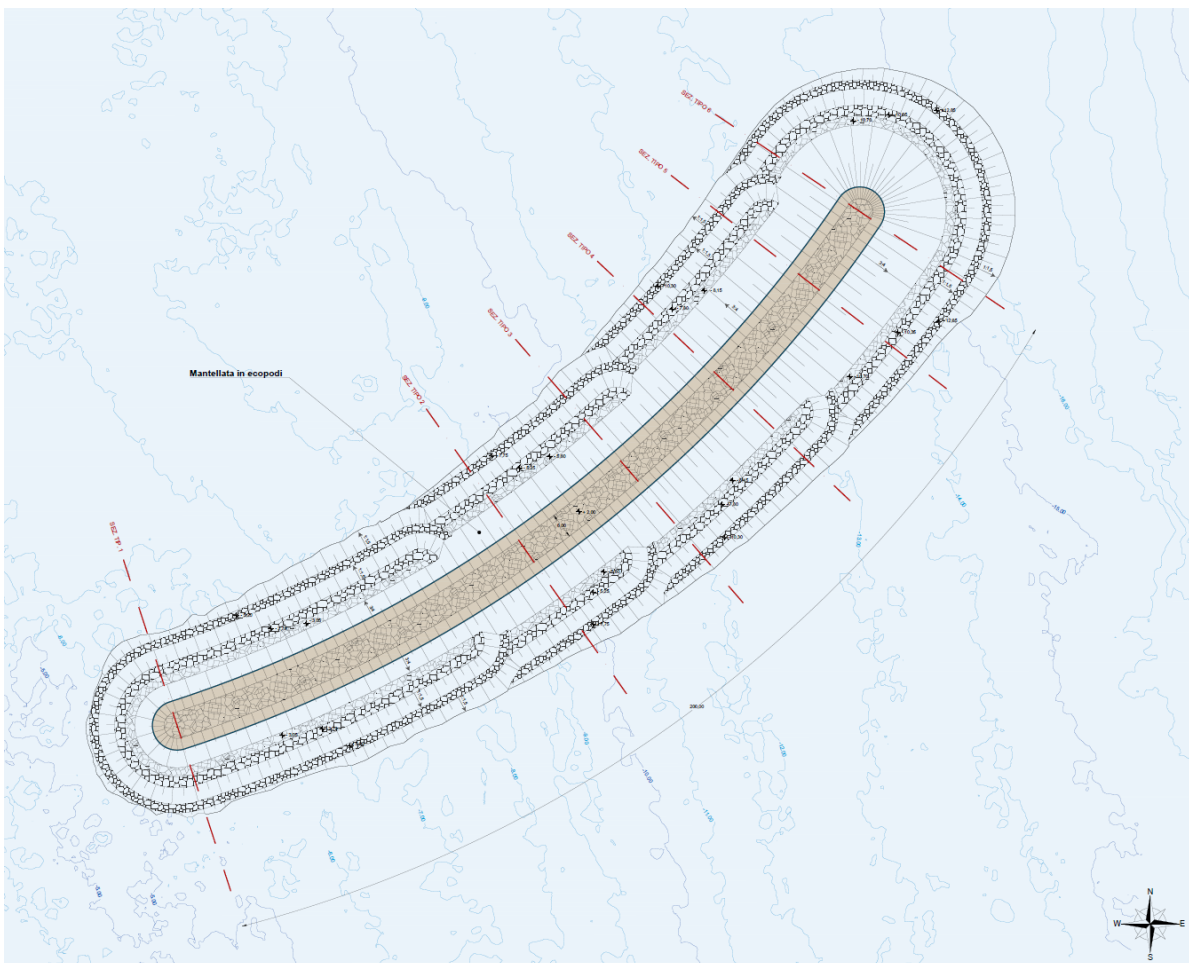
Stralcio planimetria scogliera di protezione dalle onde del II quadrante
